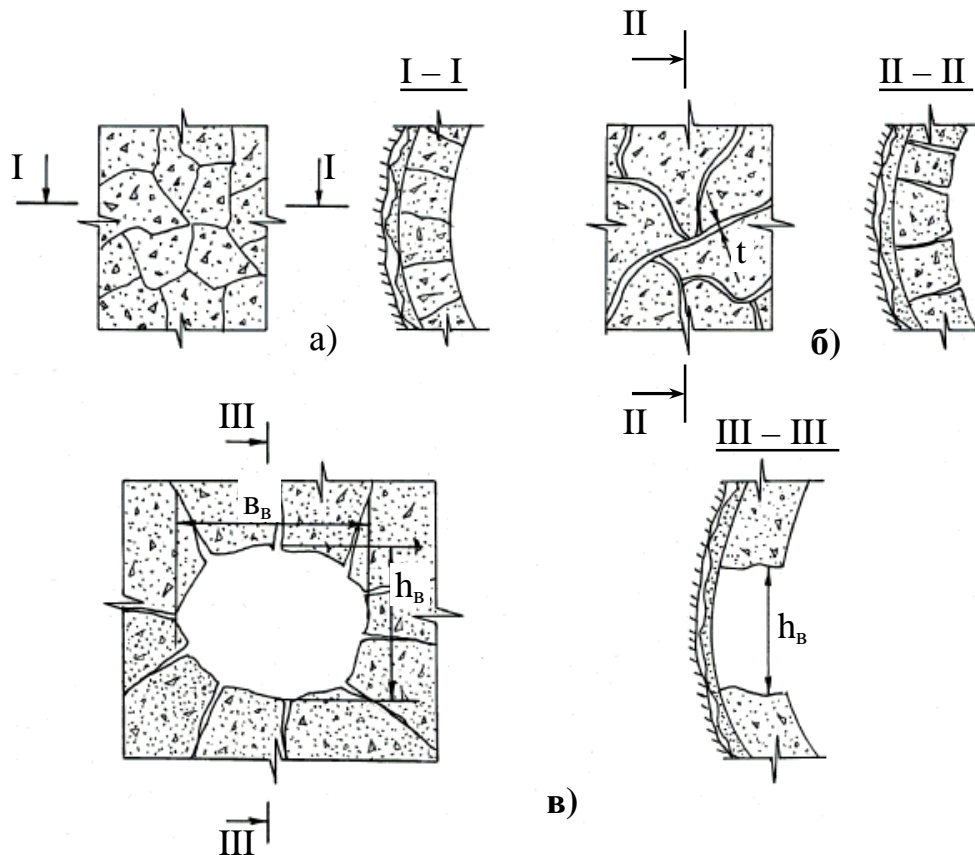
Стадии нарушенности бетонной крепи: а и б – соответственно сквозными скрытыми и раскрытыми трещинами с подвижкой нарушенных блоков; в – вывалообразование бетона
